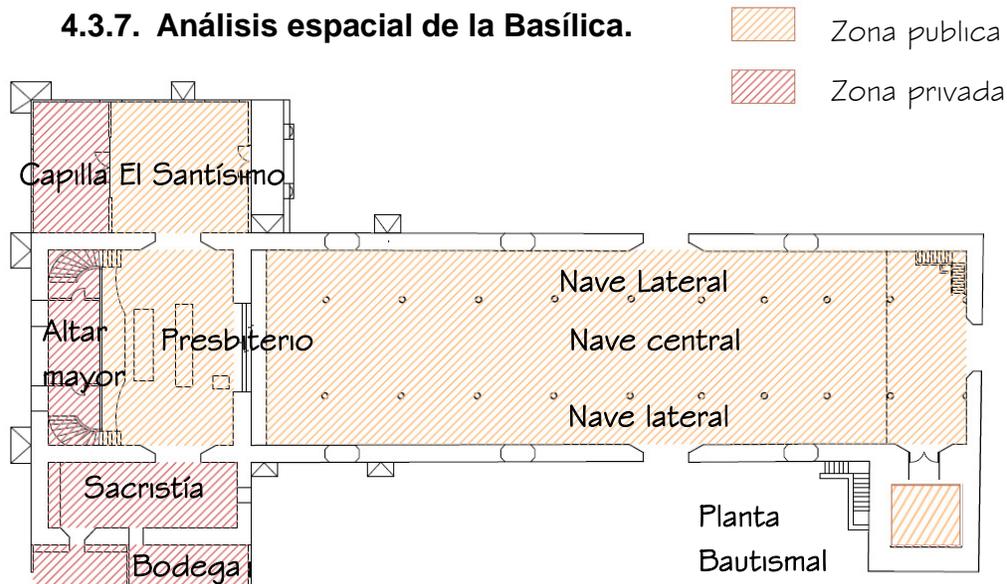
Planta arquitectónica. Autor: Grupo de trabajo.
